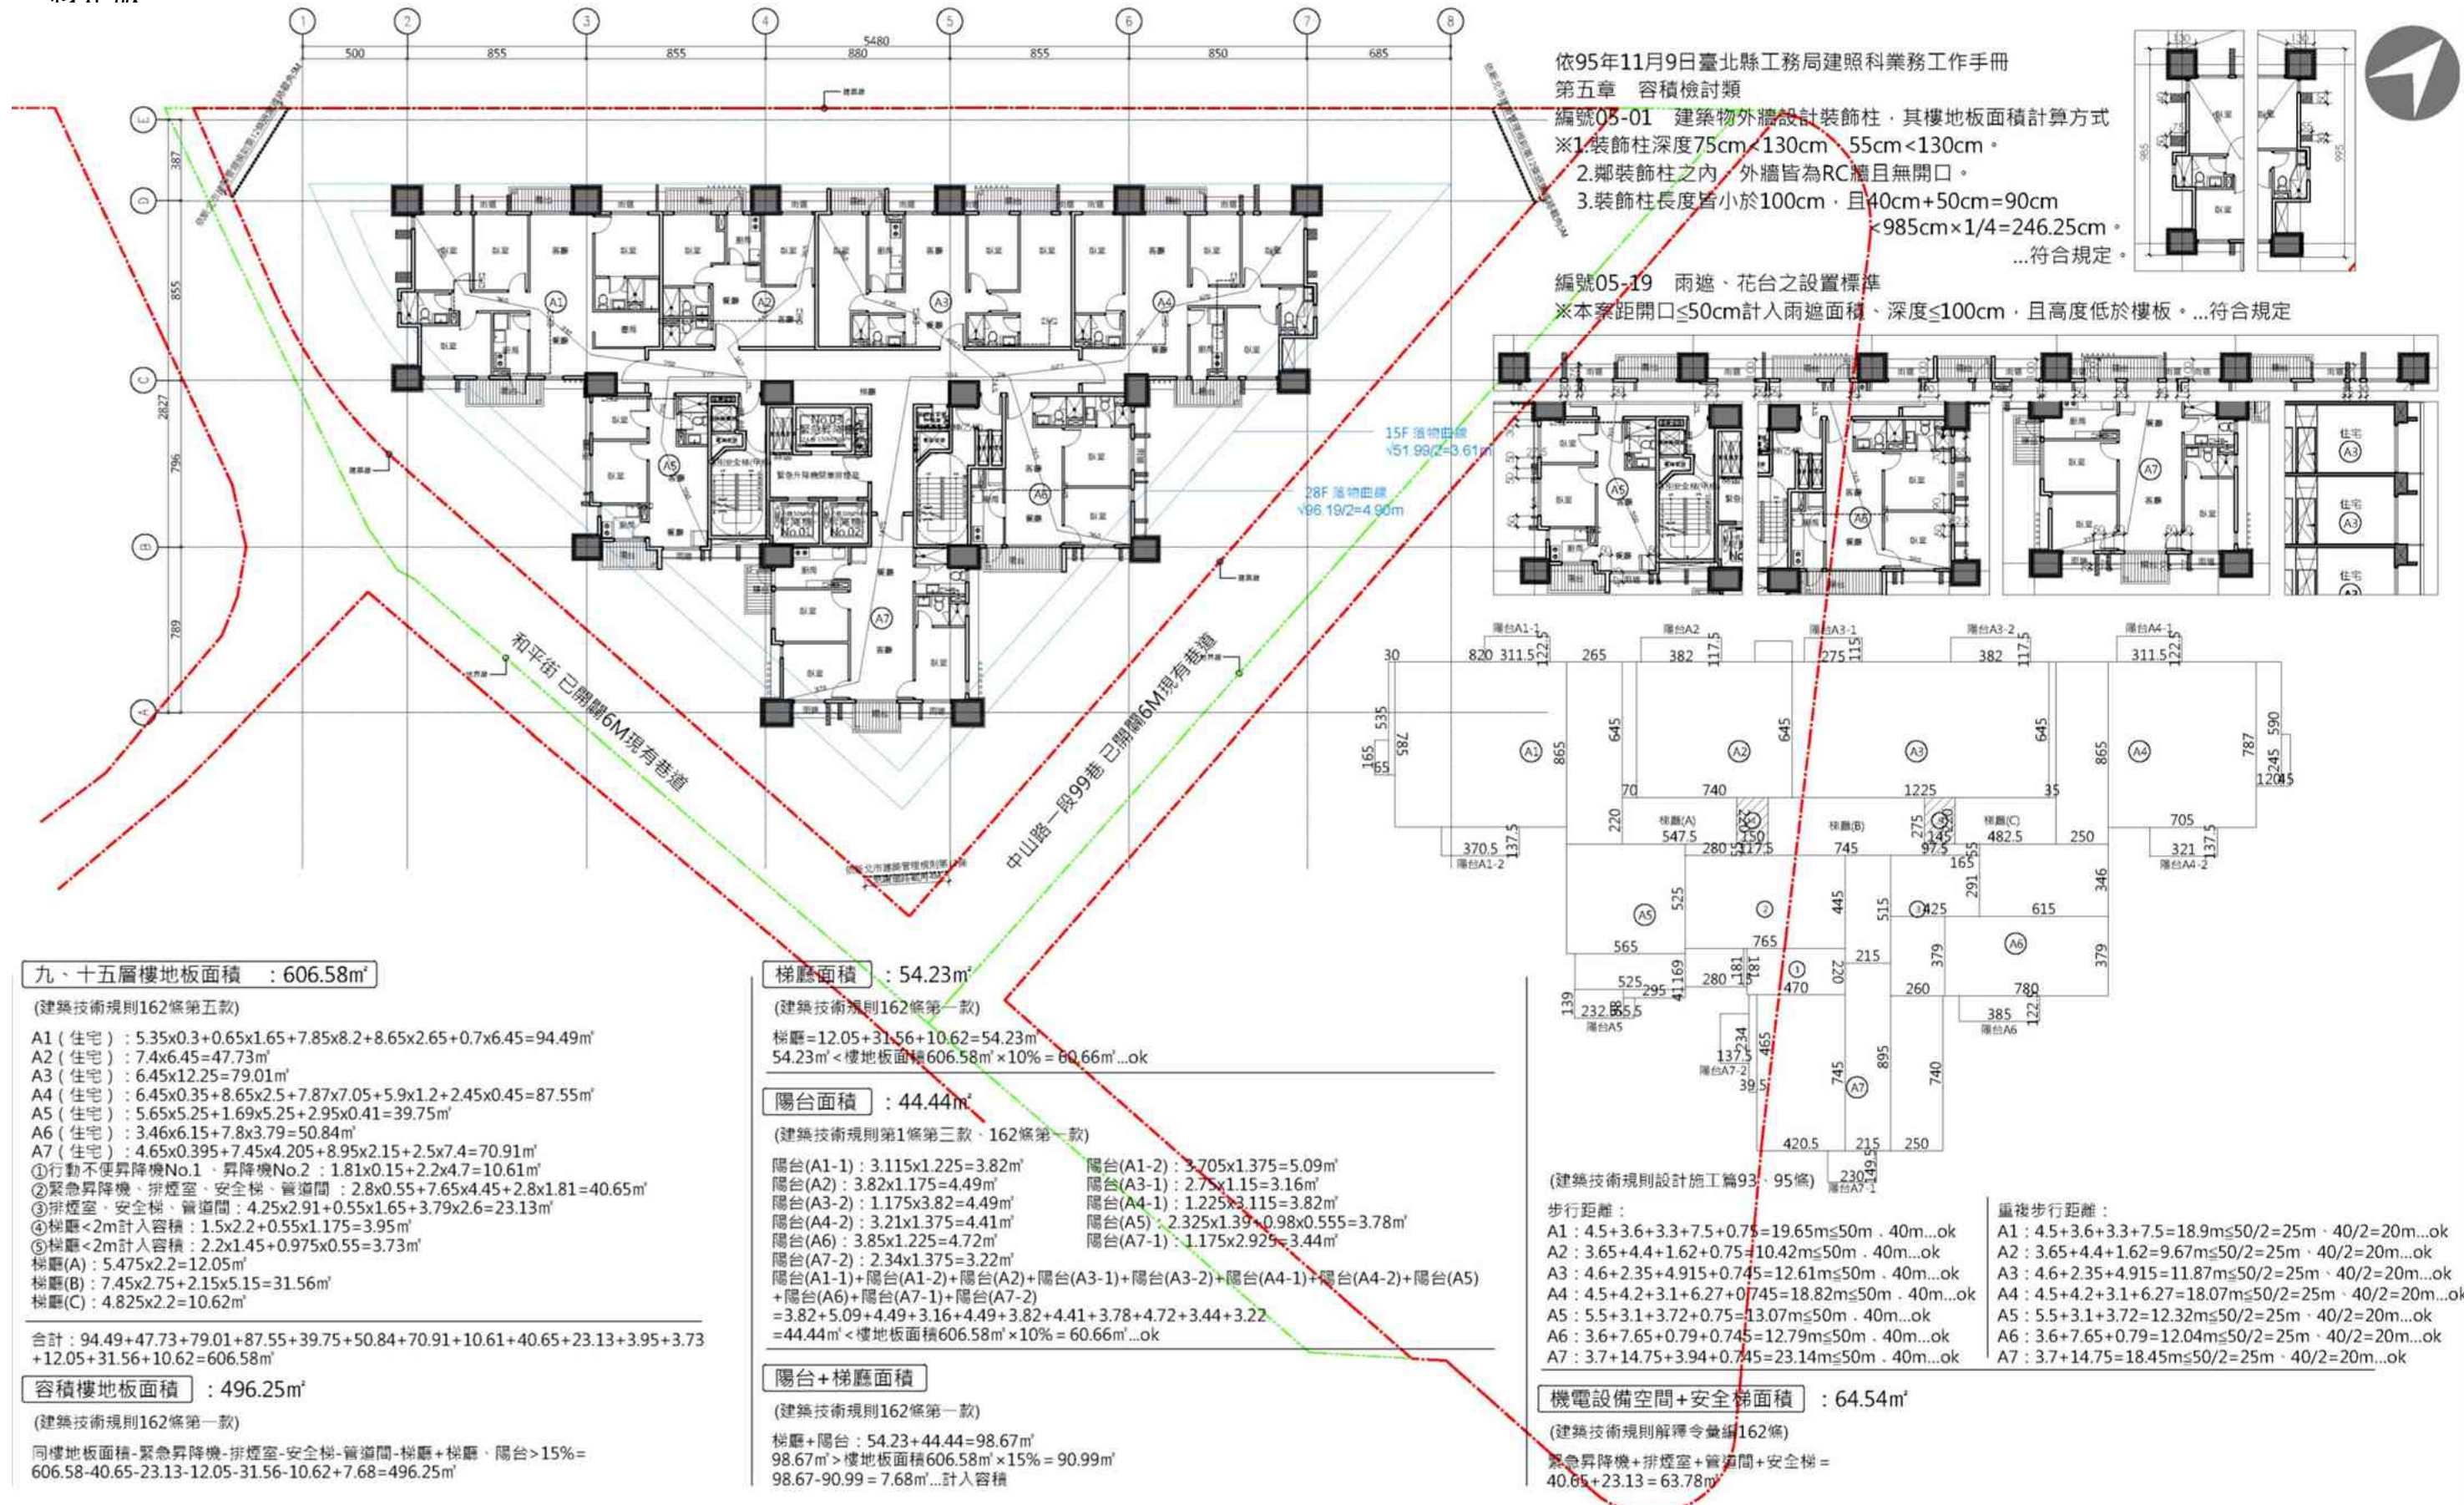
9、15F 平面圖；SCALE A3=1/300
